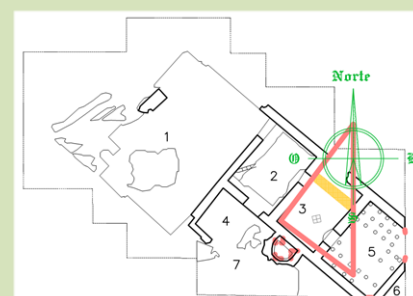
Planta de la villa de Prado con ejes compositivos. La orientación de estructuras se adapta sensiblemente a un triángulo de terna 5-12-13²⁴³. CGS.
